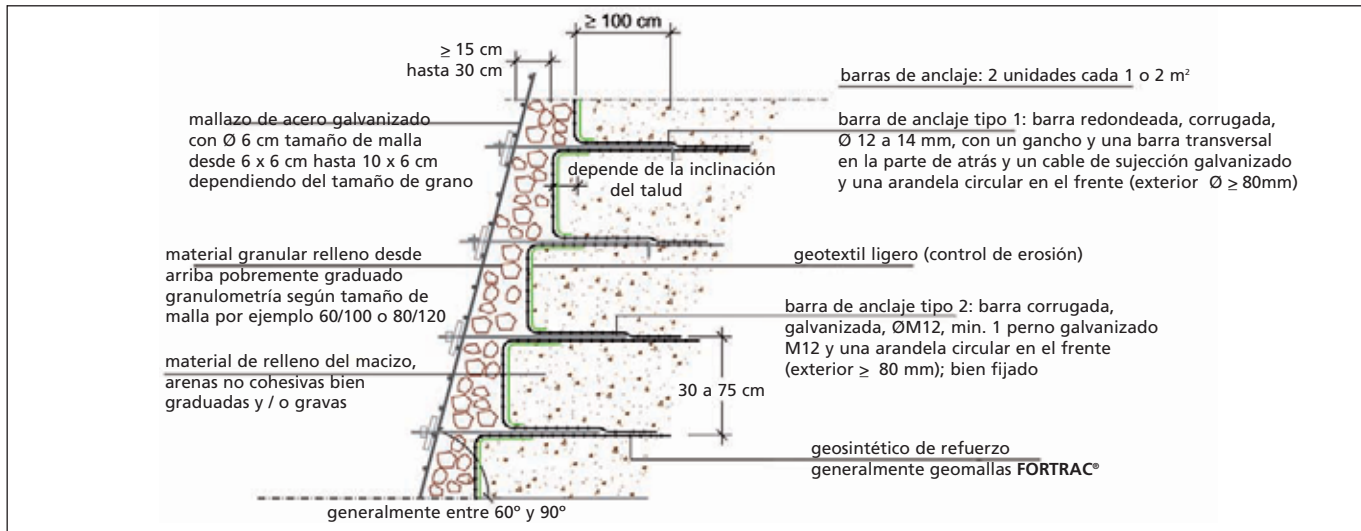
Sección típica del sistema de acabado en piedra Murallex
